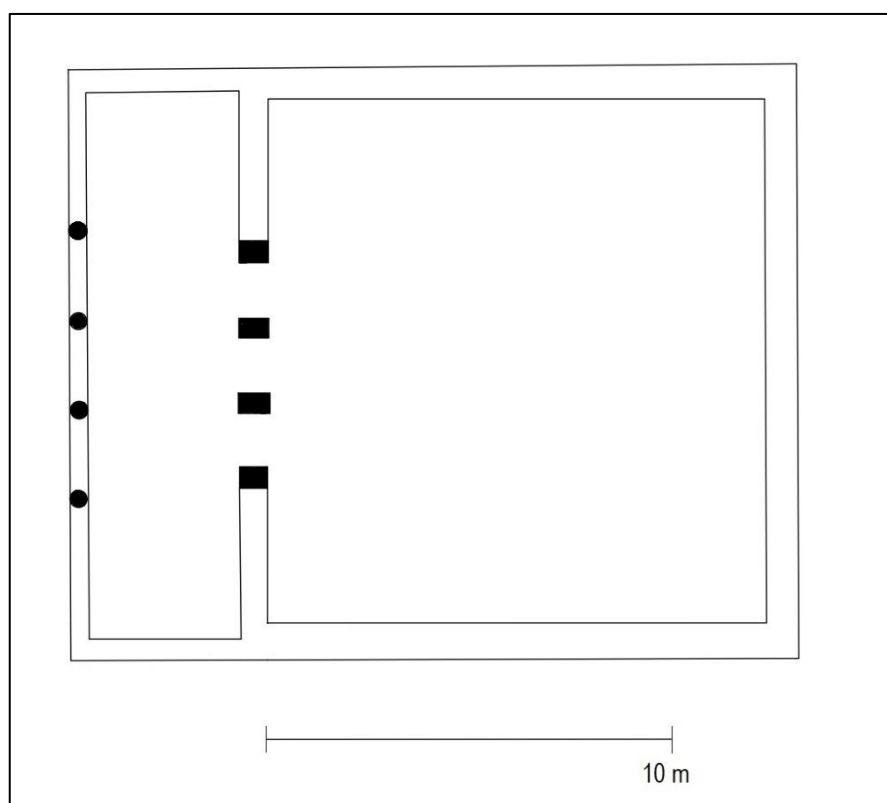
Epidauro. Planimetria generale e ipotesi ricostruttiva del tempio II (ROUX 1961).
